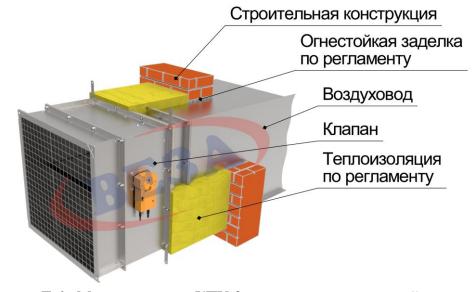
Монтаж клапана КПУ-3 вне проема строительной конструкции
